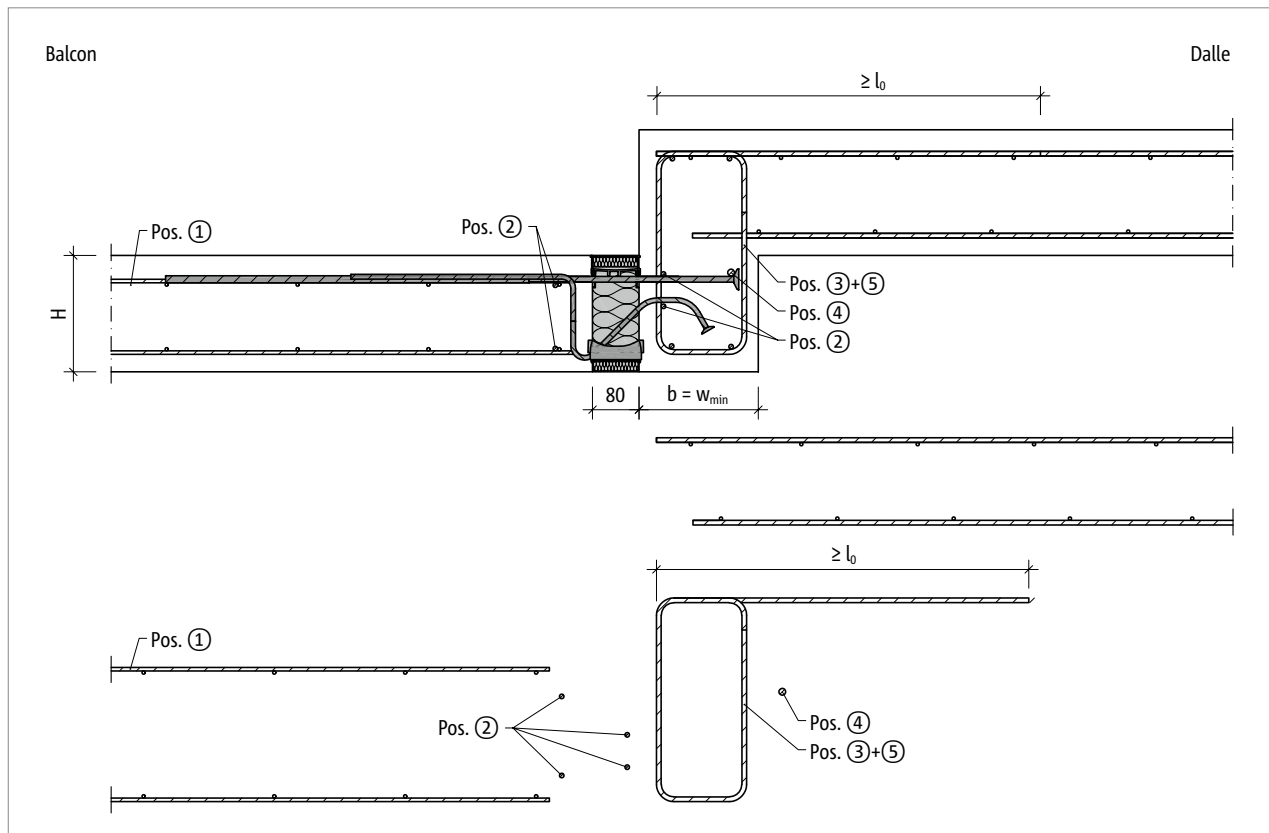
Schöck Isokorb® T type K-U : Renforcement sur site pour balcon avec décalage vers le bas avec une dimension minimale du composant ($w_{pres} = w_{min}$)
